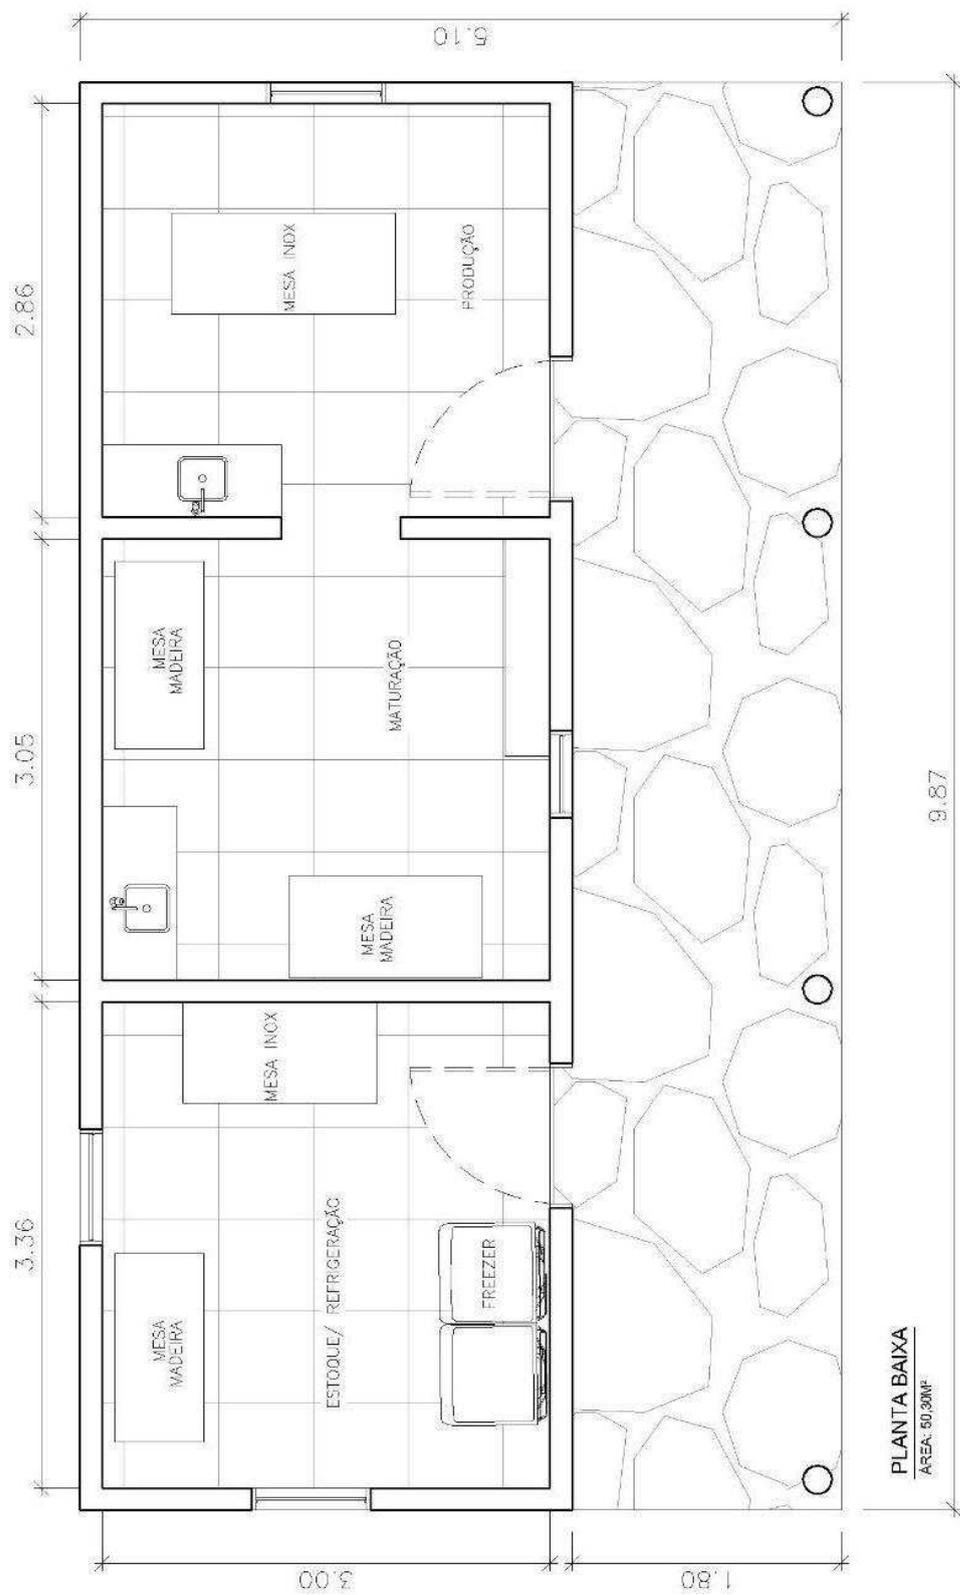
Planta baixa da Queijaria L. Fonte: Autora, 2021.
